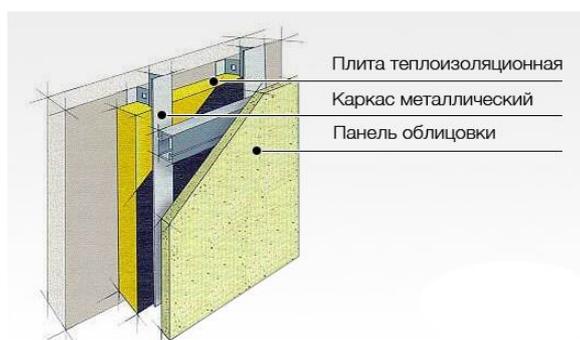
Способ дополнительного утепления стен использованием экрана на отnose
